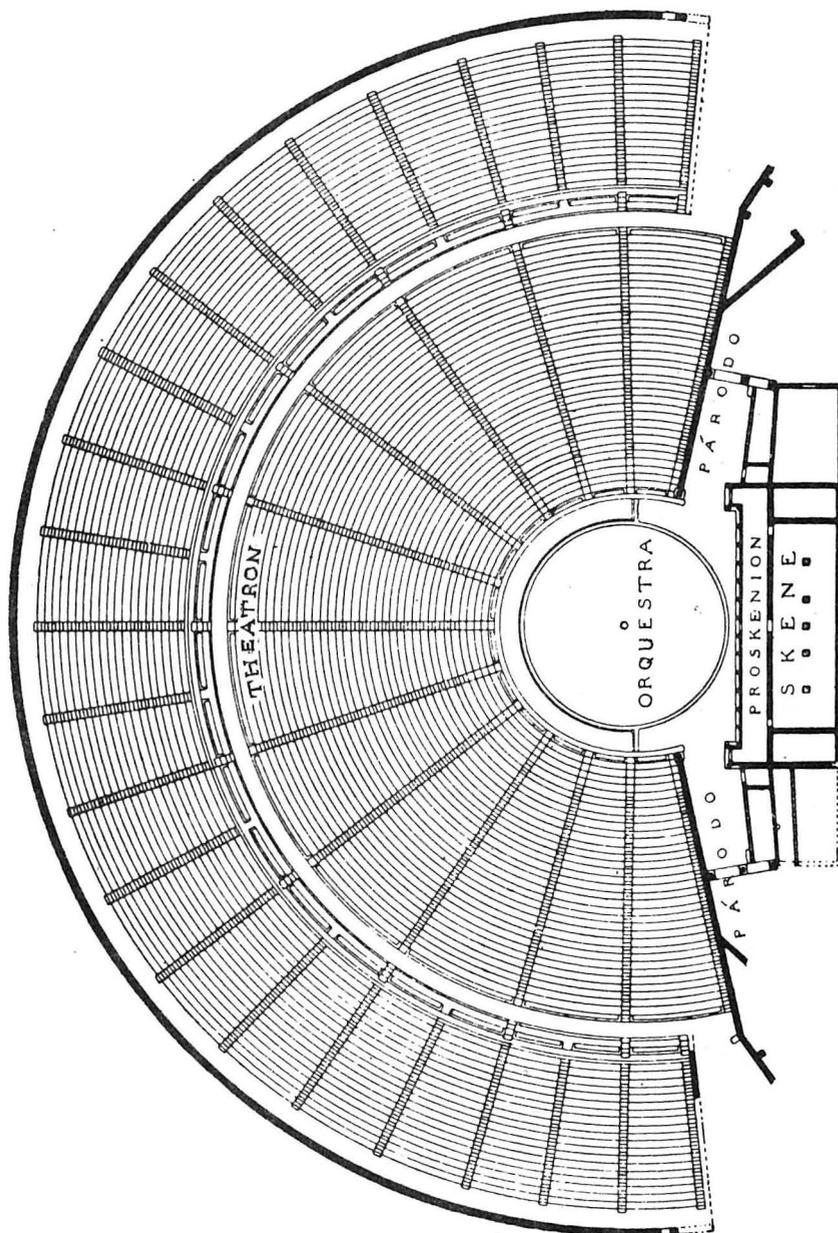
PLANTA DO TEATRO DE EPIDAURO
